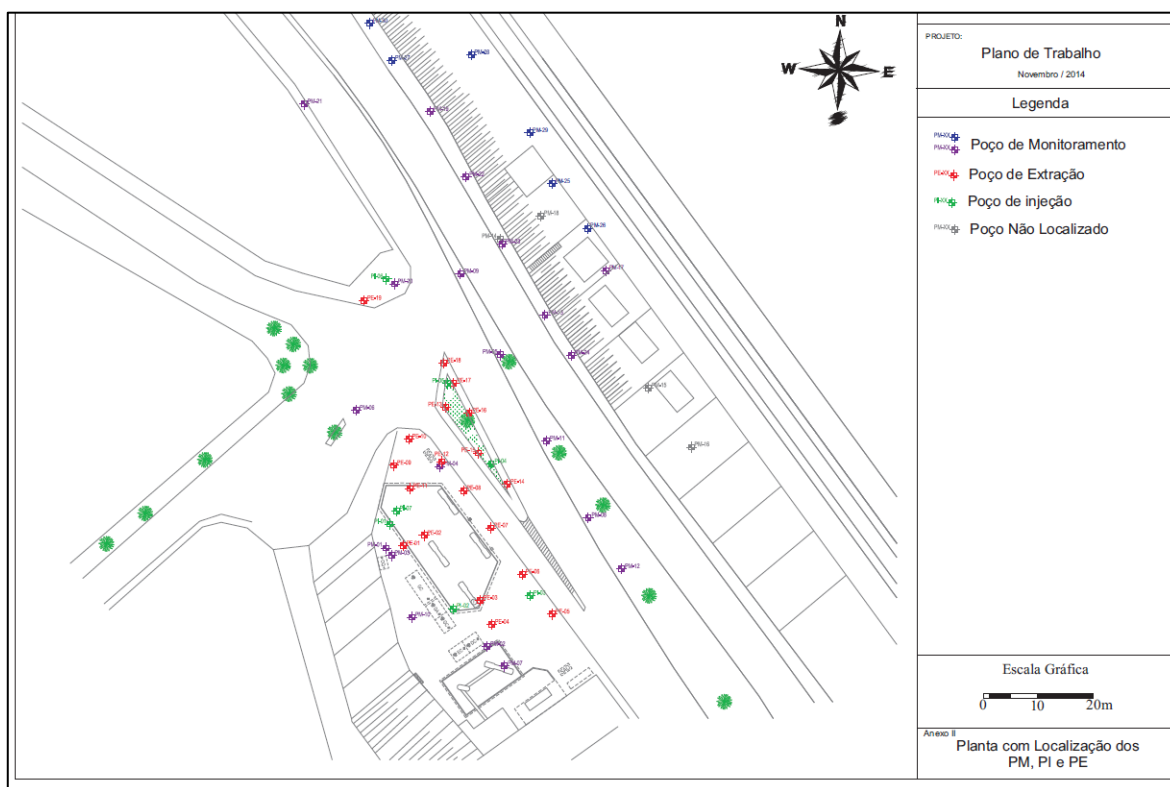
Planta com a localização dos PM, PI e PE - 2014
